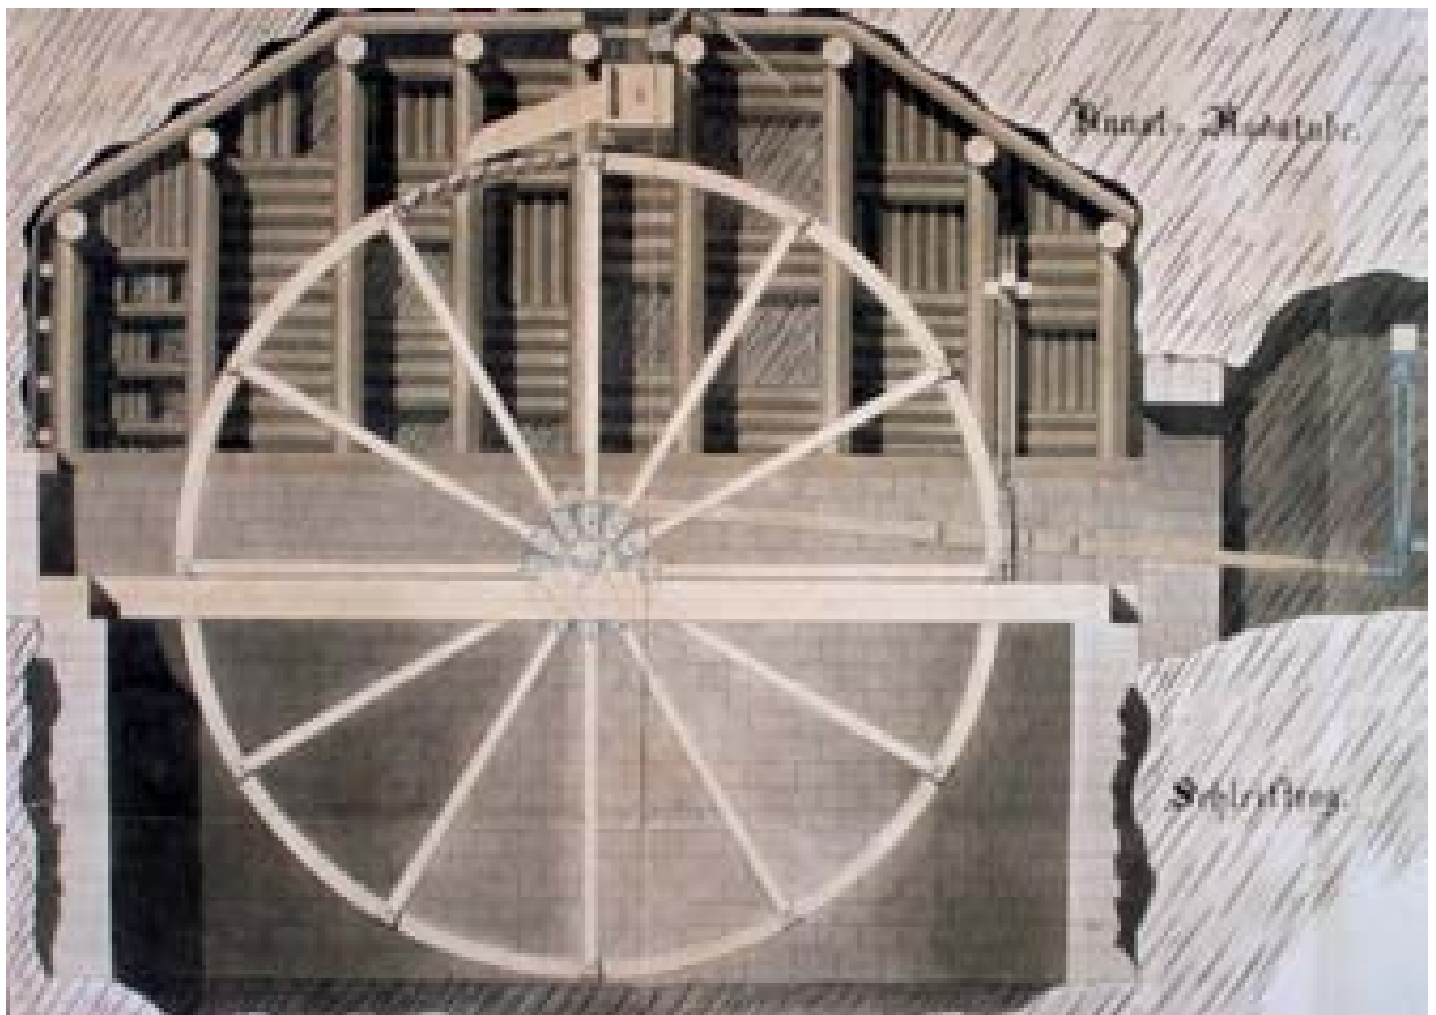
(Ausschnitt): Wasserzulauf zum Kunstrad. (A. Polle)
